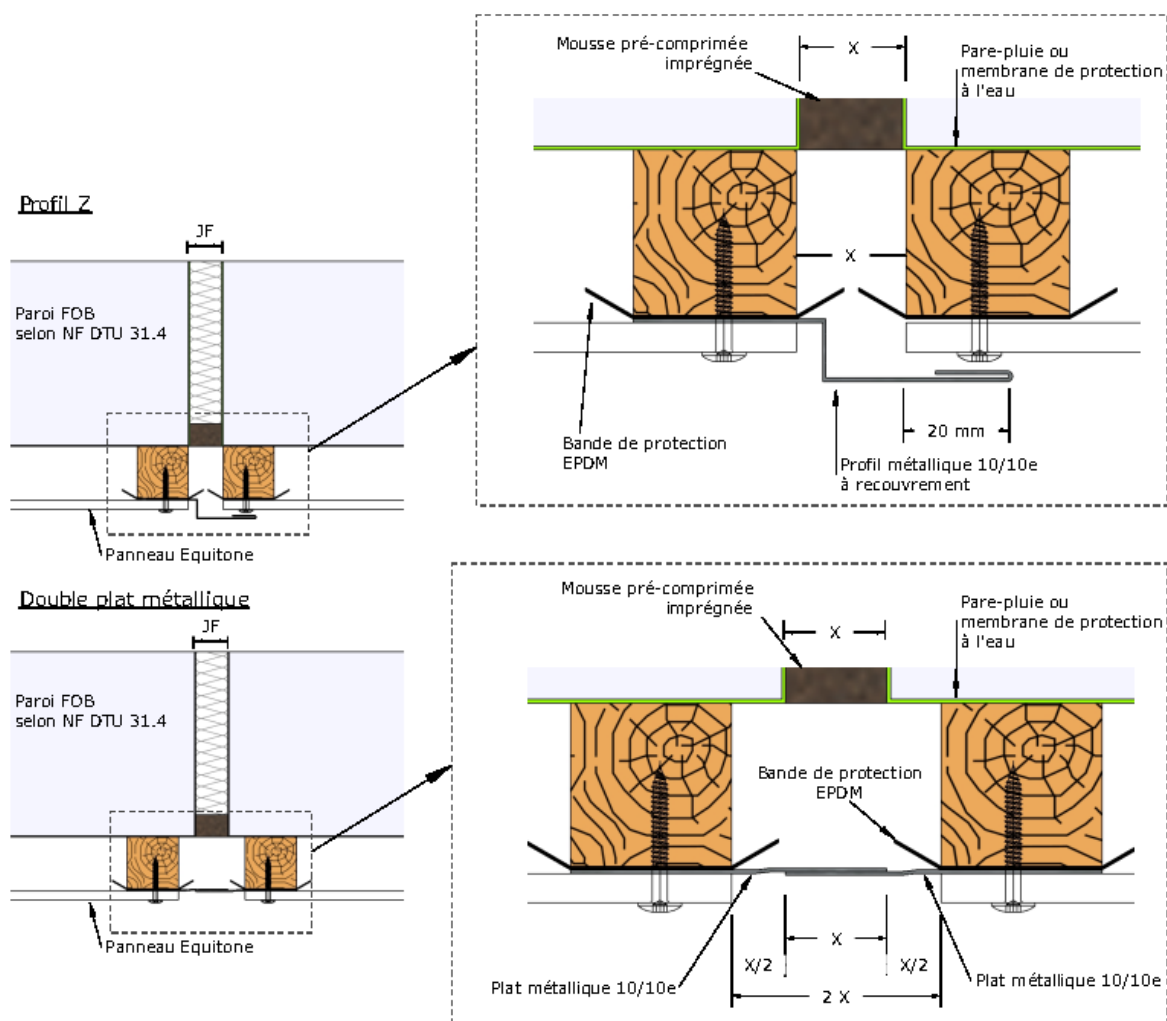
Jeu fonctionnel vertical Ee1, coupe horizontale
